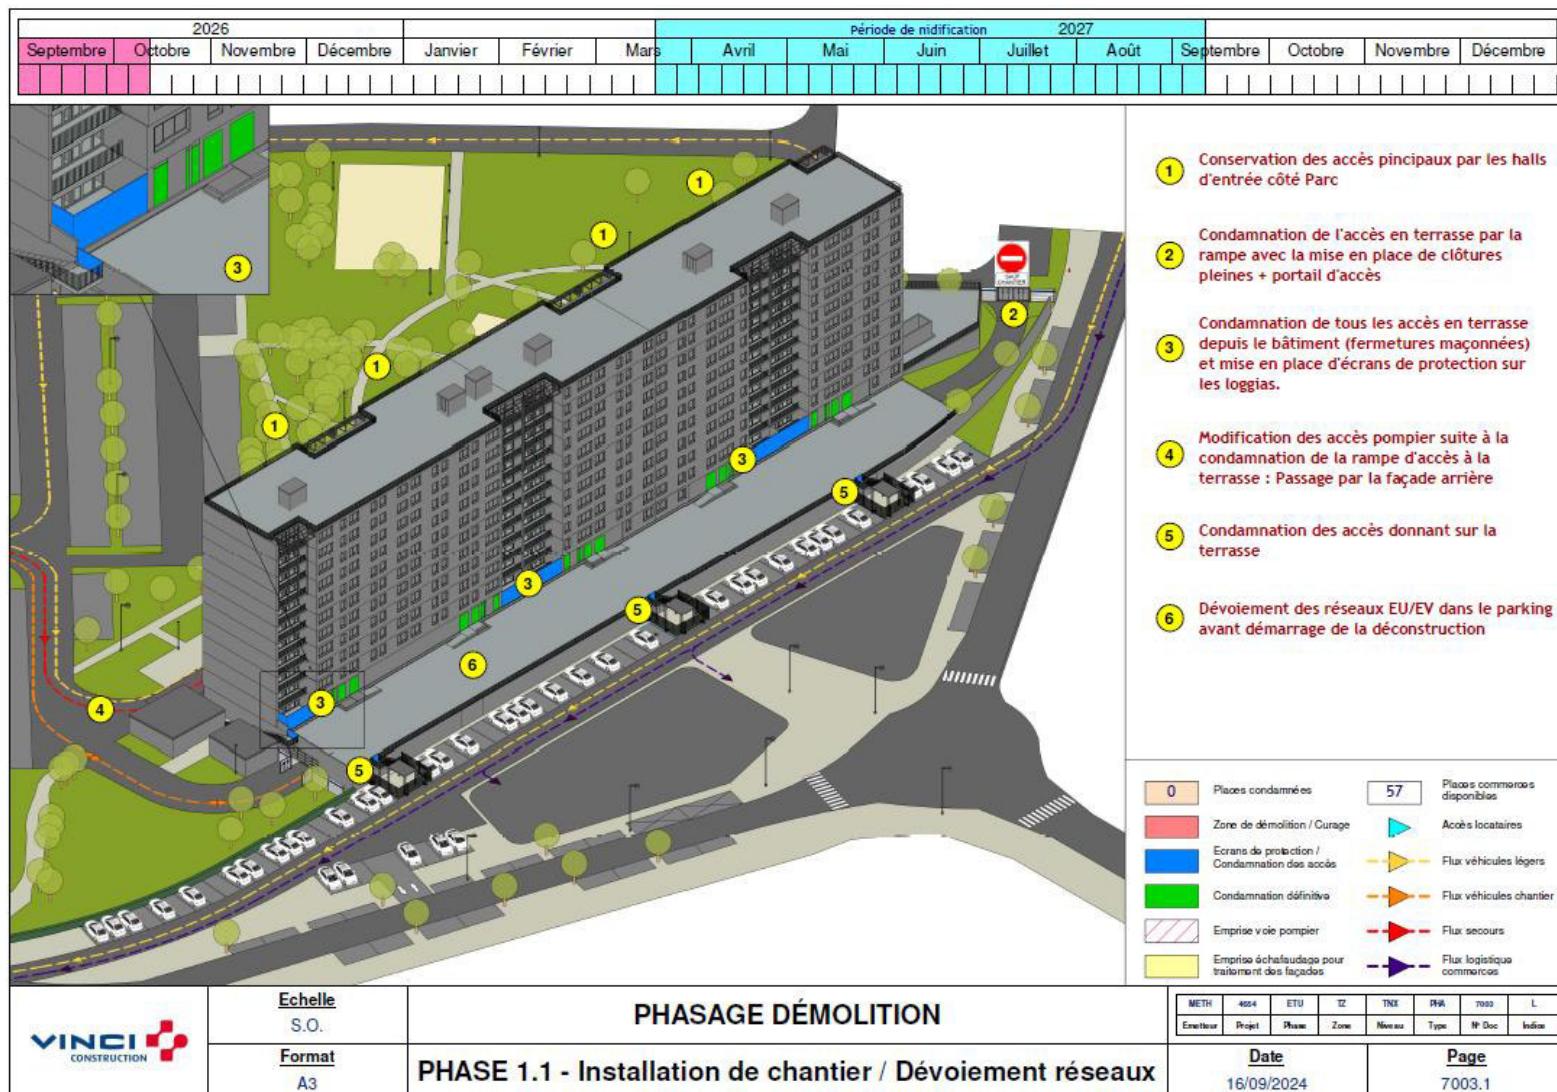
Extrait du PIC - Phase installation de chantier (Source : VINCI construction, 16/09/2024)
